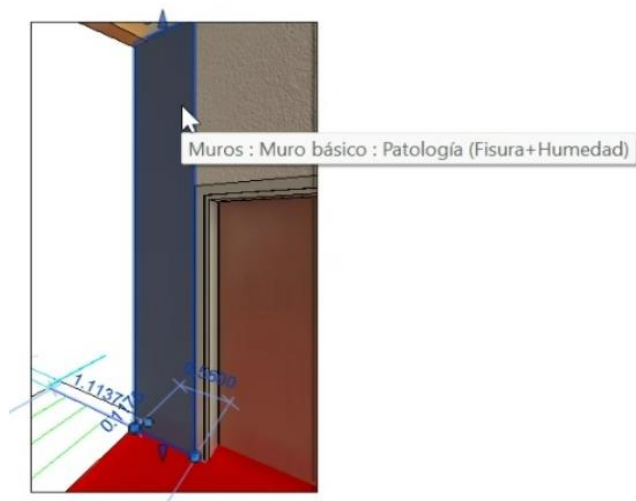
Patología de Fisura y Humedad, Fuente: Propia
